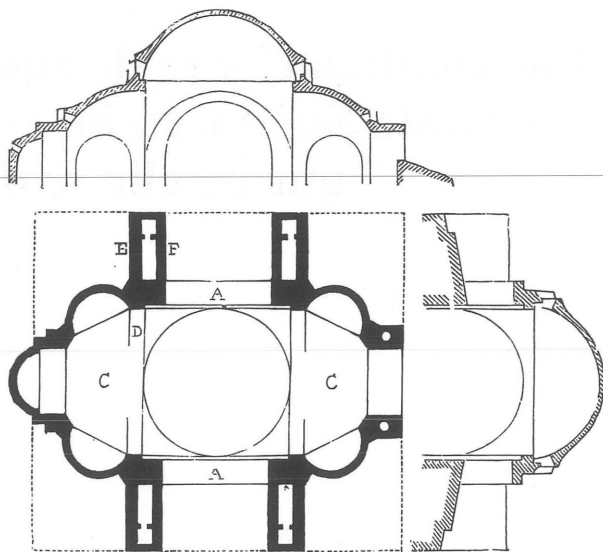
Santa Sofía de Constantinopla. Planta y secciones
